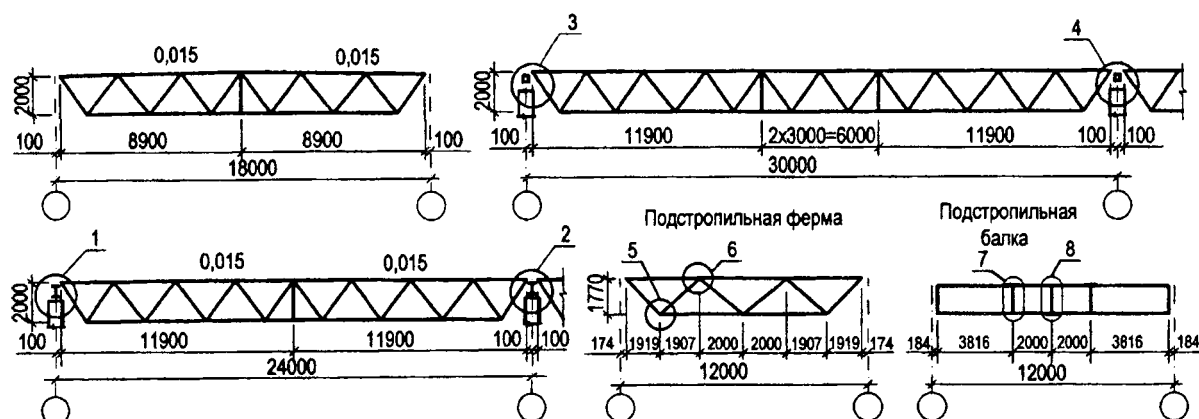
Геометрические схемы ферм из замкнутых гнутосварных профилей типа «Молодечно» (серия 1.460.3-14)
